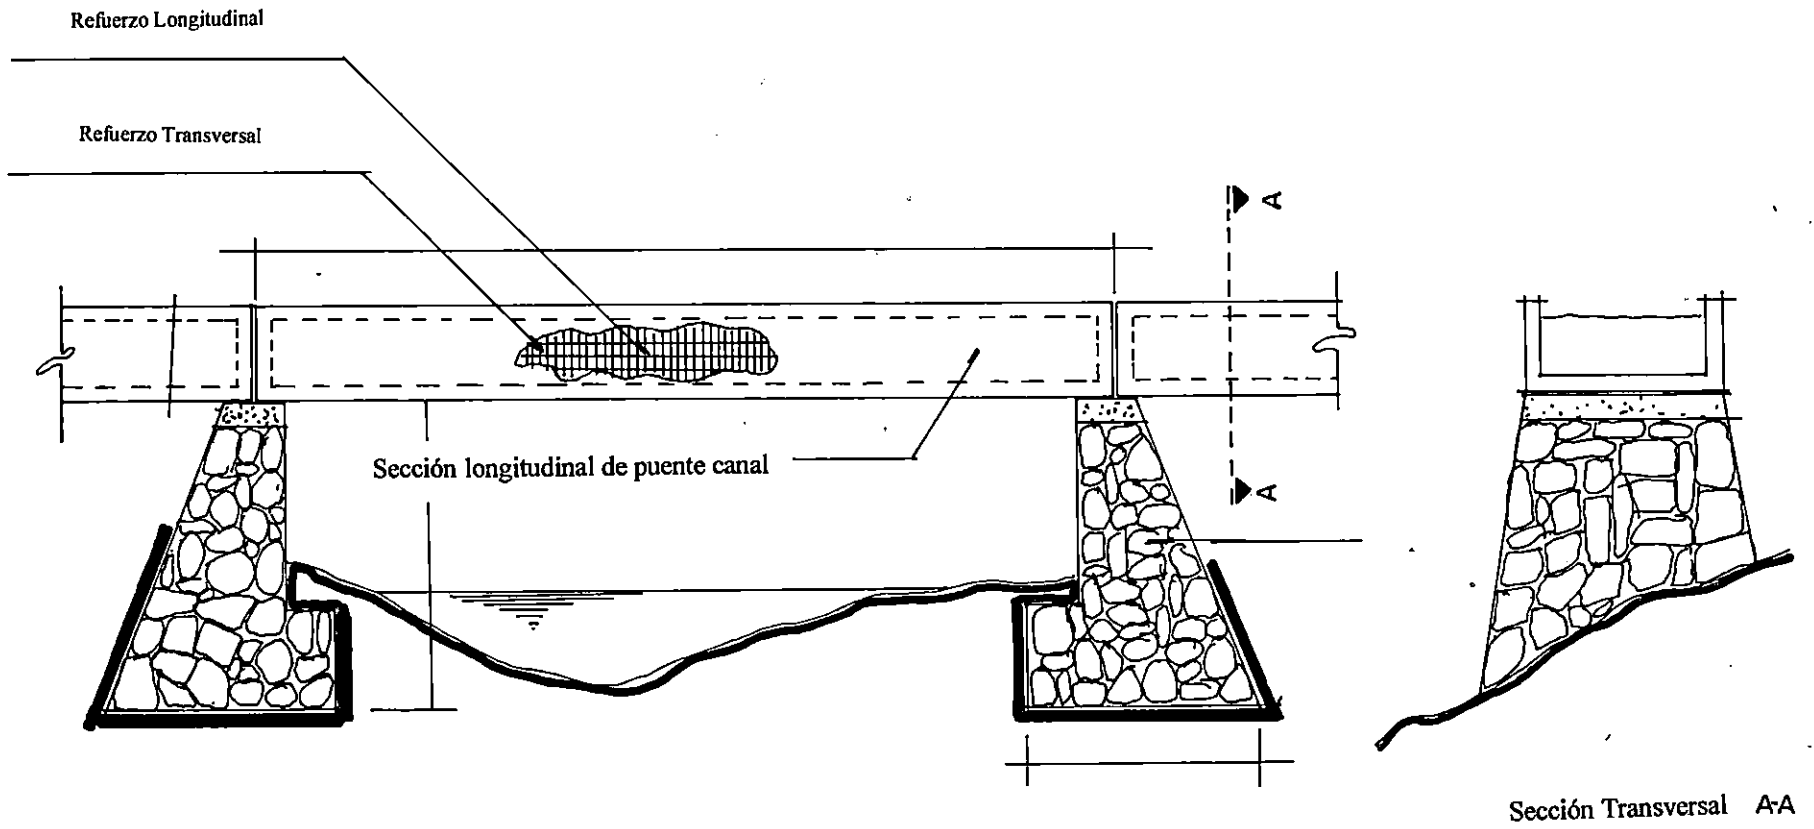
Puente Canal de Concreto Reforzado
